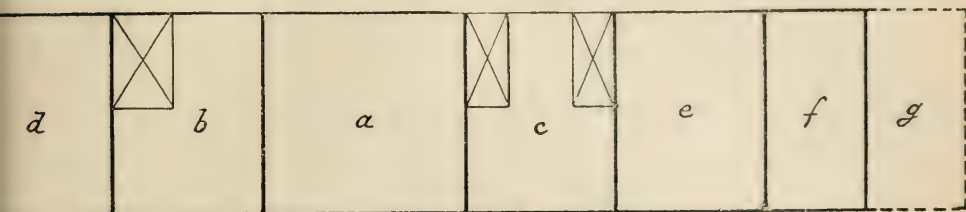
Plan du logement d'un Chef d'entreprise.
